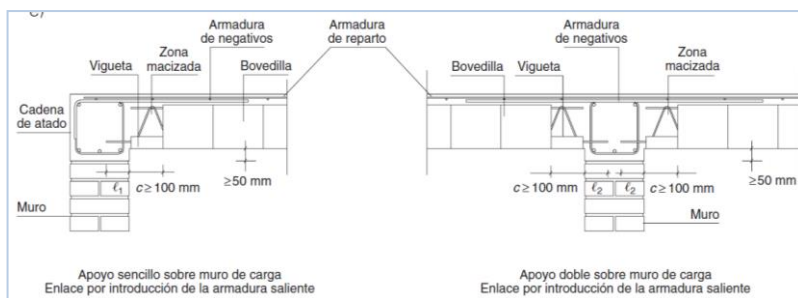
y 22. Apoyo sobre muro de carga. Enlace por introducción de la armadura saliente
